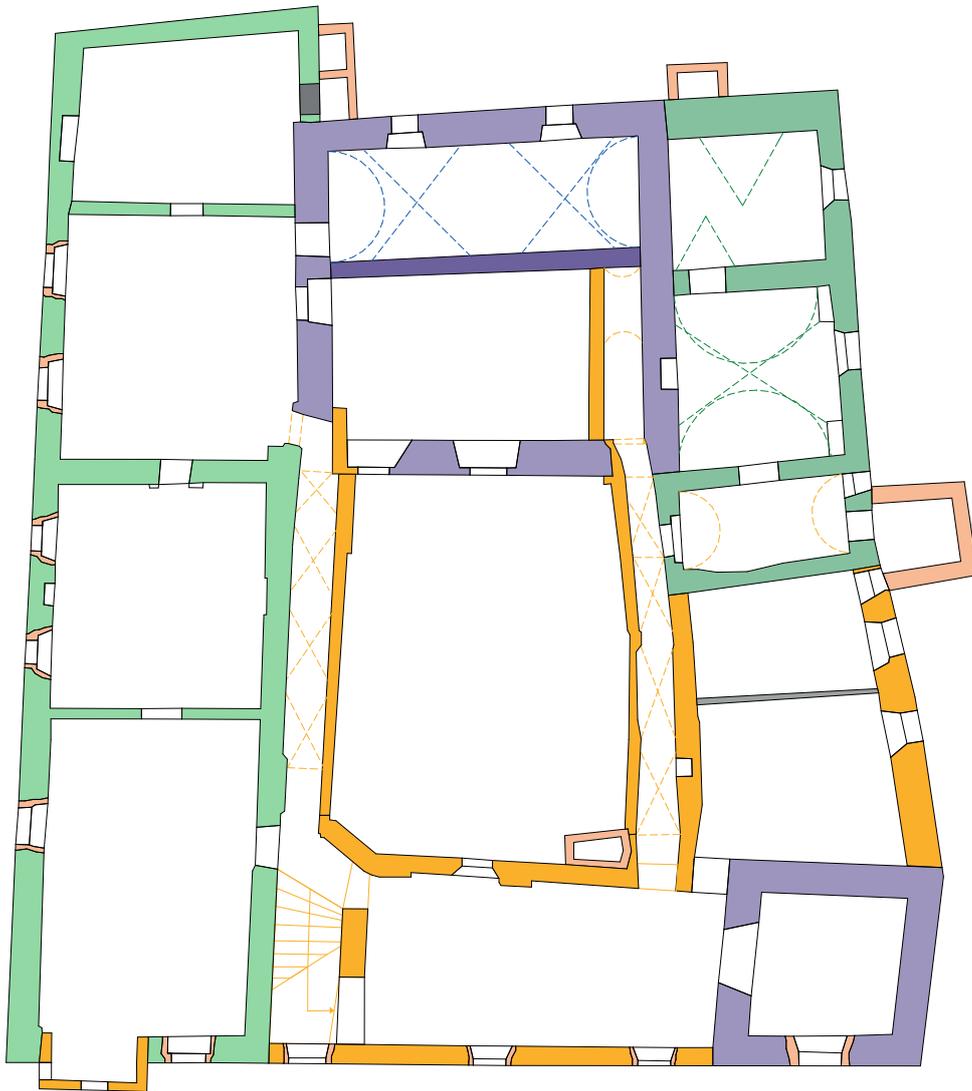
Baualterplan 1.Obergeschoss; M1:200
